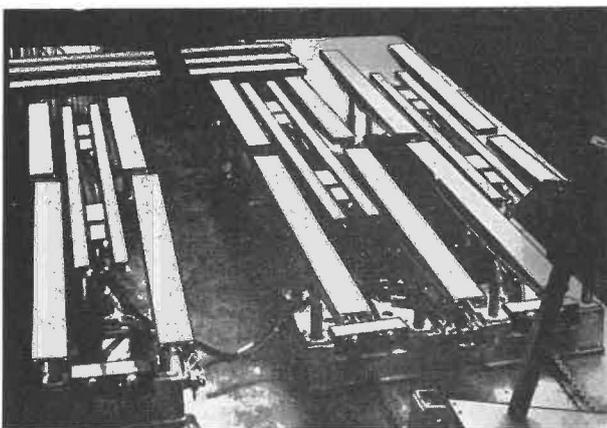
Soutènement mécanisé Seaman Gullick pour extrémités de taille.
